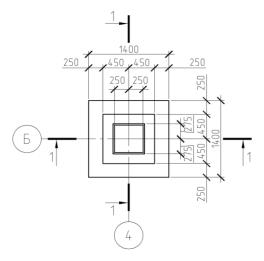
Пример оформления плана ростверка отдельного свайного фундамента
